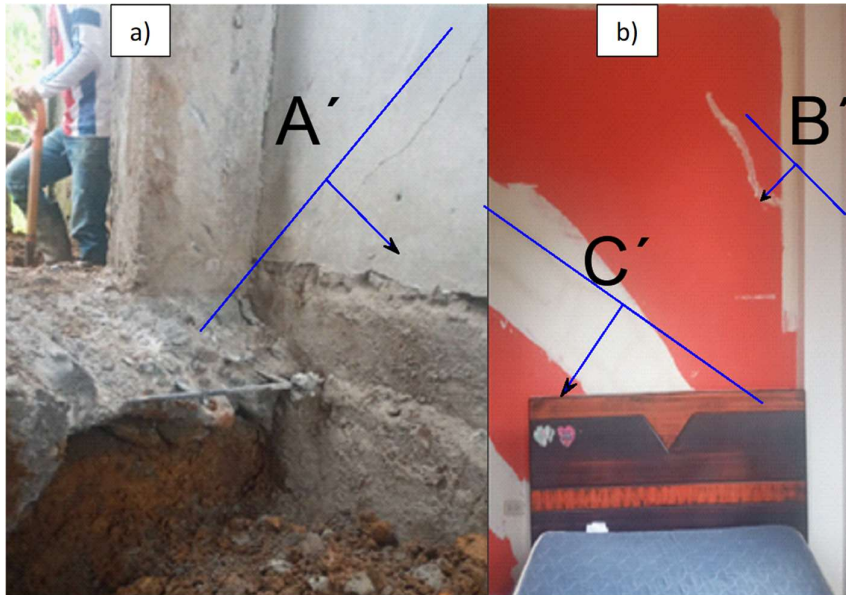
Irregularidades de la pared adosada. La imagen a) muestra la fisura de la pared adosada, donde se evidencia los 45° de inclinación. Además, se observa, la escasa profundidad de la cimentación. La imagen b) muestra el lado opuesto de la pared que se aprecia en a), con la particularidad que la pared ya se encuentra reparada. Las flechas azules, representan la dirección de asentamiento, y las letras mayúsculas A', B' y C' corresponden a la identificación de las irregularidades.
